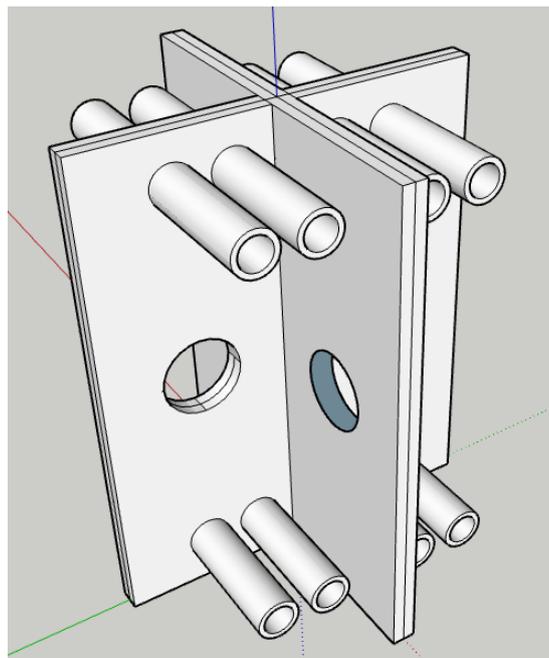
試験体 No. 3 の内蔵鋼板の立体図
